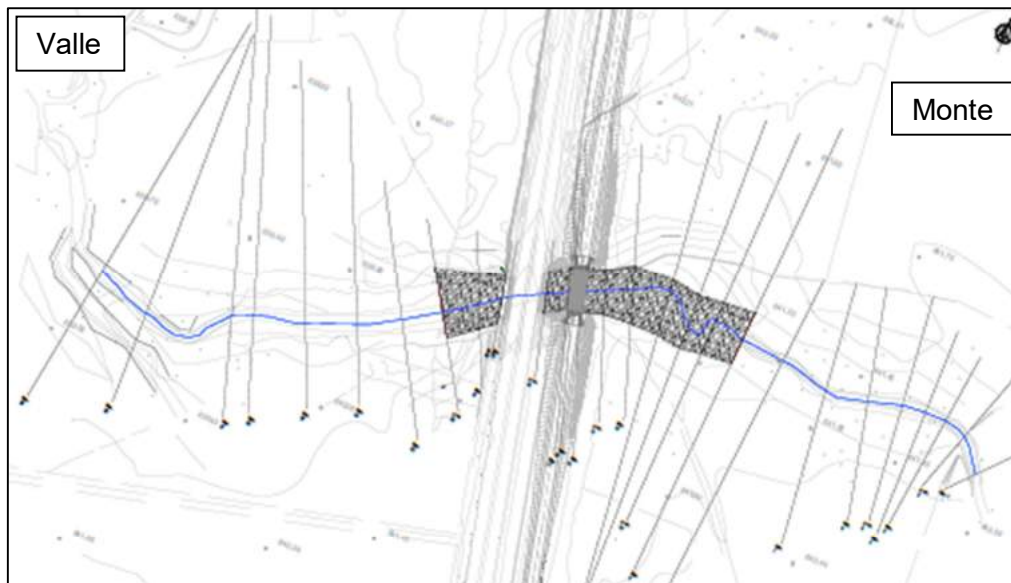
Stralcio planimetrico di inquadramento dell'attraversamento sul Riu Temo (Fiume 625) tramite ponticello idraulico L=27 m – PO06 SU S17 al km 154+495.
